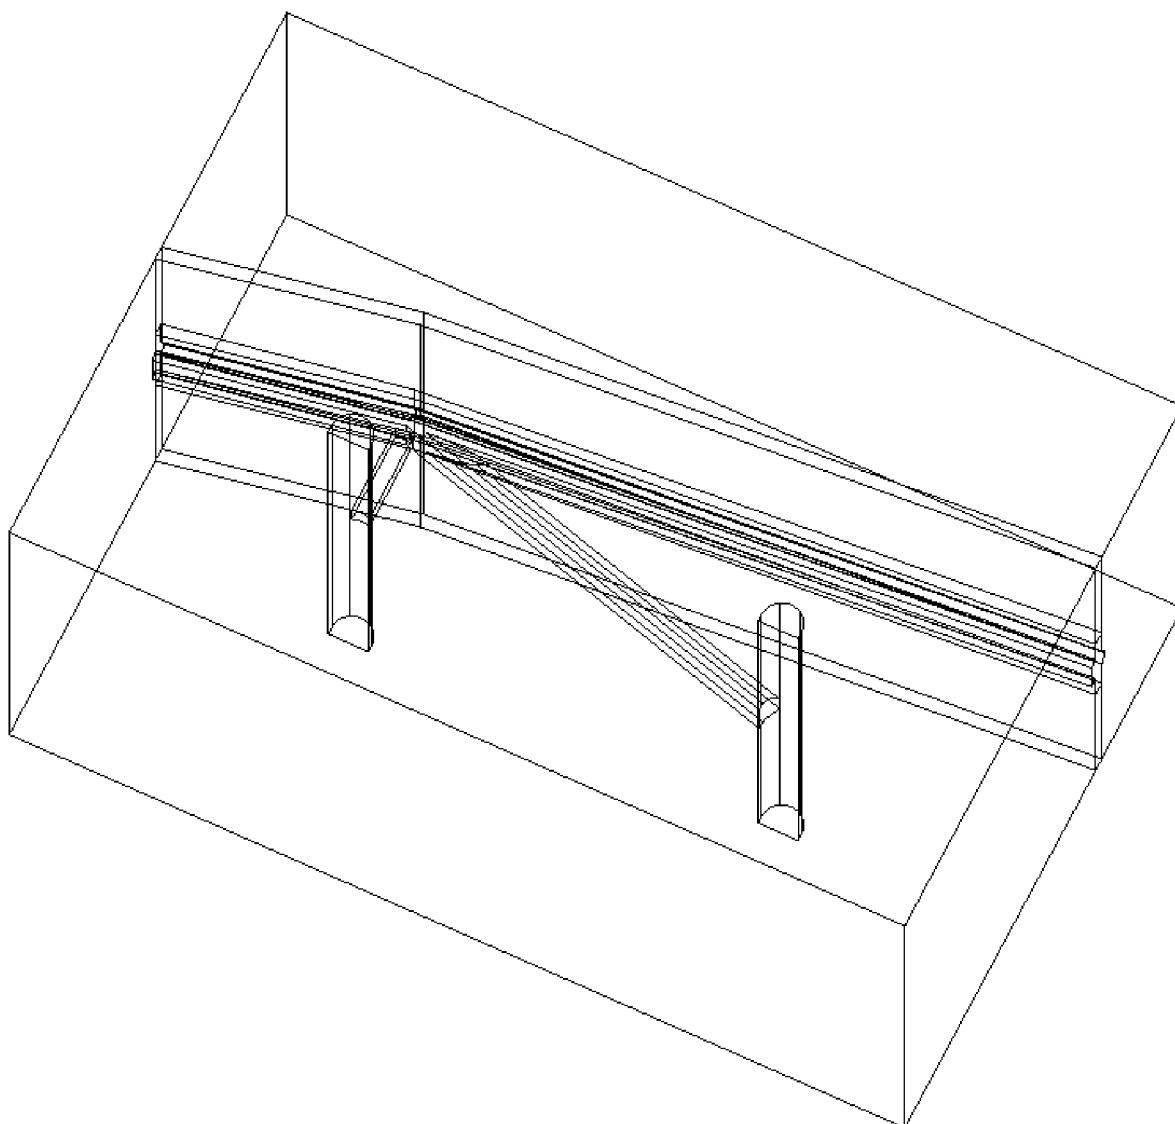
Розрахункова схема побудована AutoCad (об’ємна)
